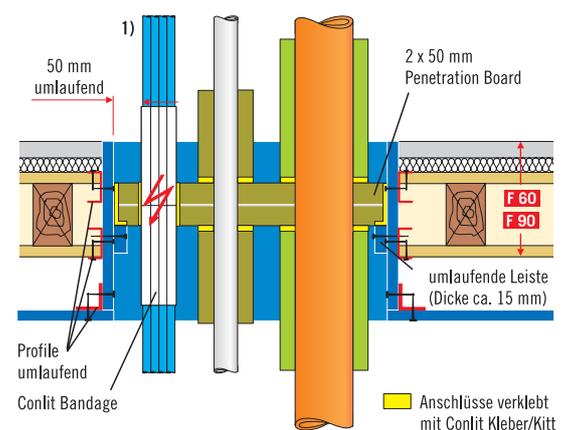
Beispiel zur Abschottung einer Holzbalkendecke mit F 90-Unterdecke und Rockwool Penetration Board innerhalb einer F 90-Auslaibung
